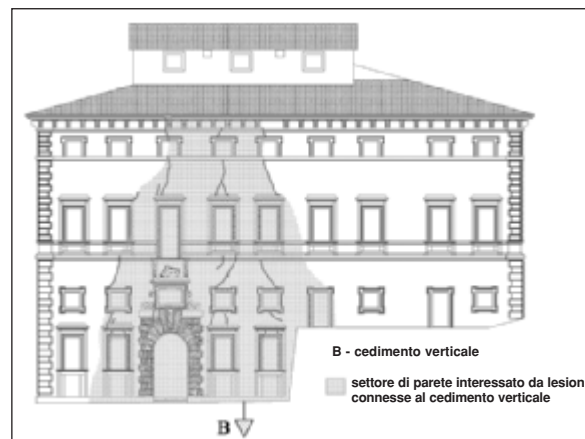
Settore della parete perimetrale Est interessato dal cedimento fondale.
